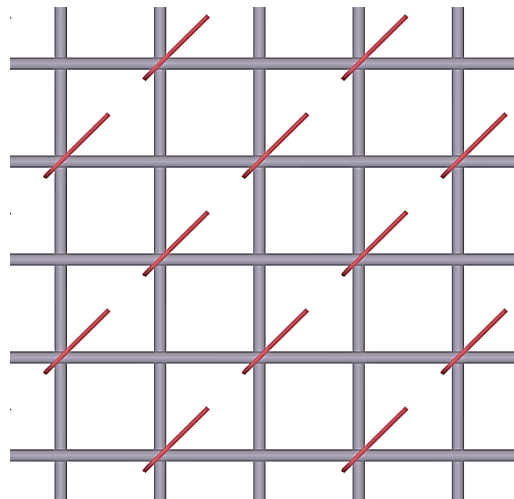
Поперечное армирование в плитах перекрытия и покрытия, cm^2/m^2
